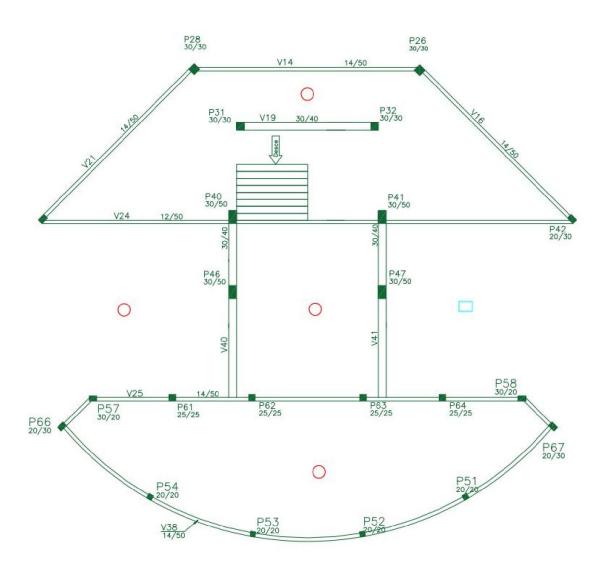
Mapa iluminado do pavimento térreo do AUDITÓRIO.
